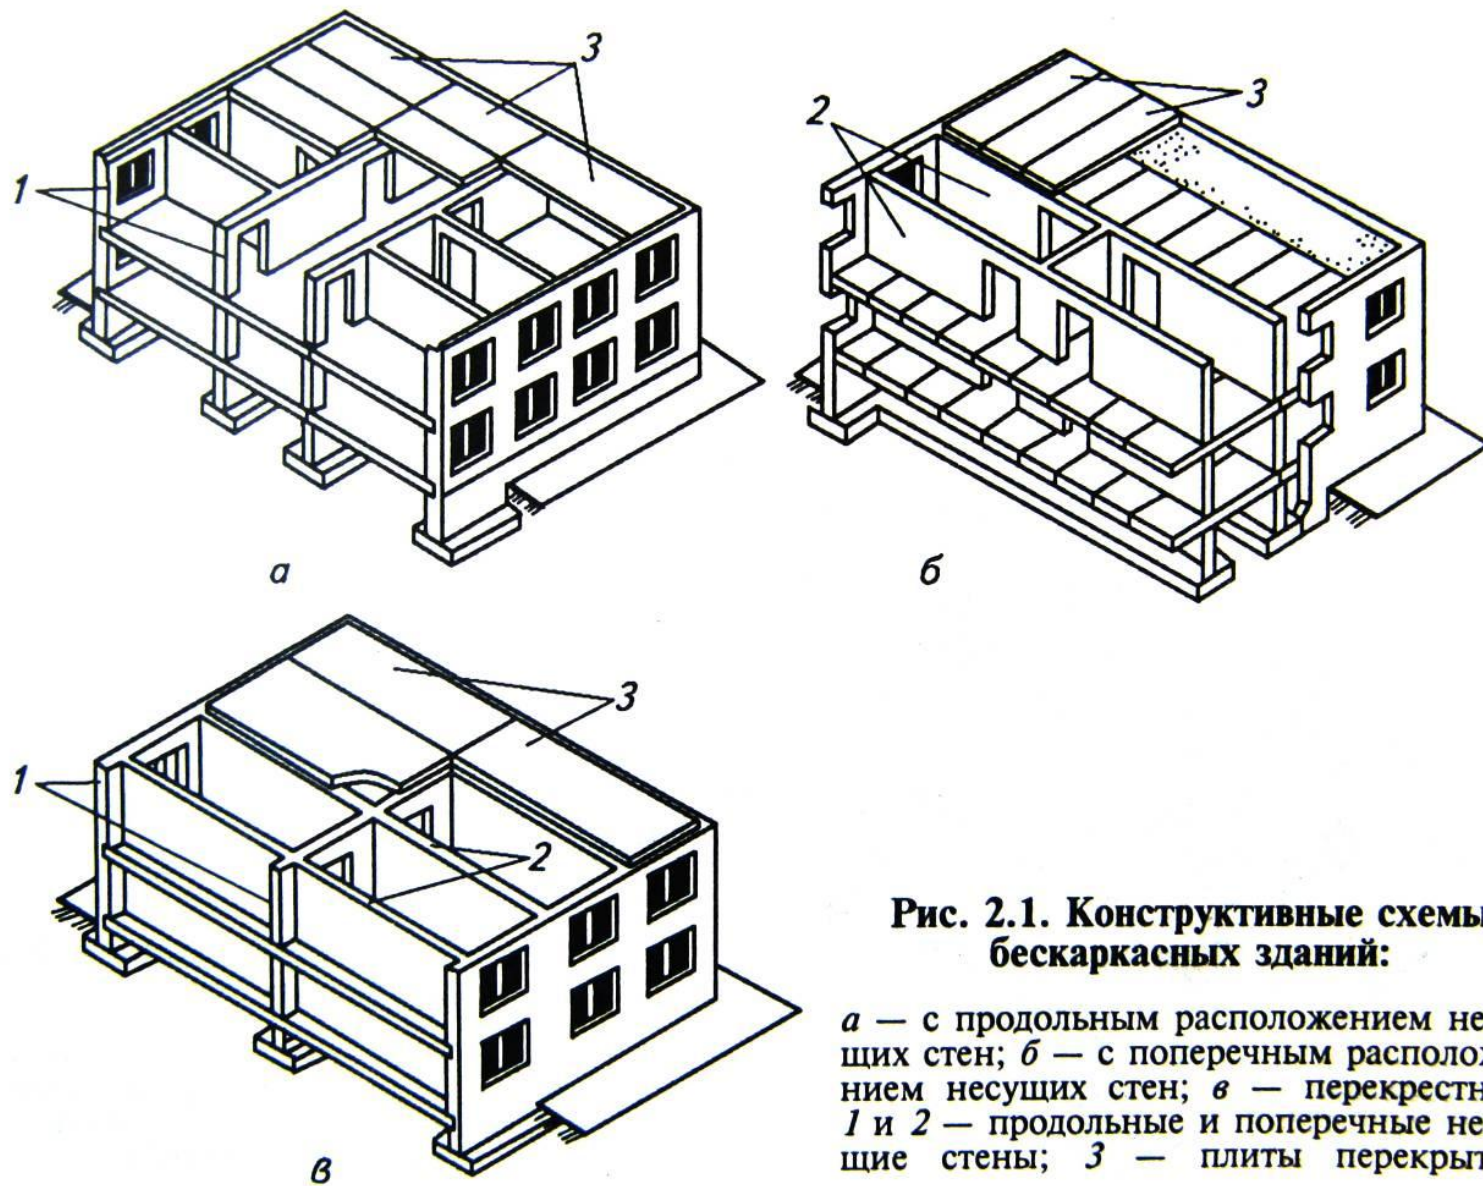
Конструктивные схемы бескаркасных зданий:
